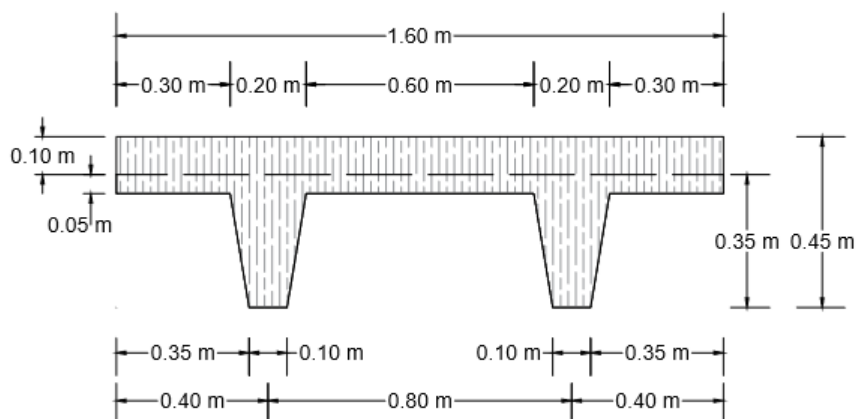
Dimensiones de la sección TT constante más carpeta de 0.10m.
